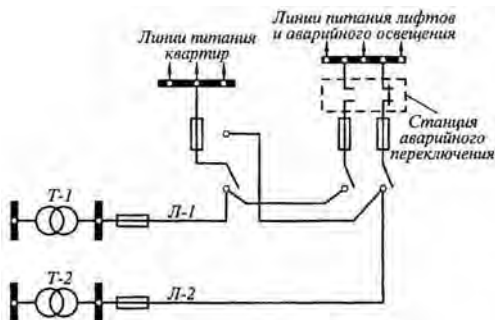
Схема питания напряжением до 1 кВ жилого дома выше 16 этажей
